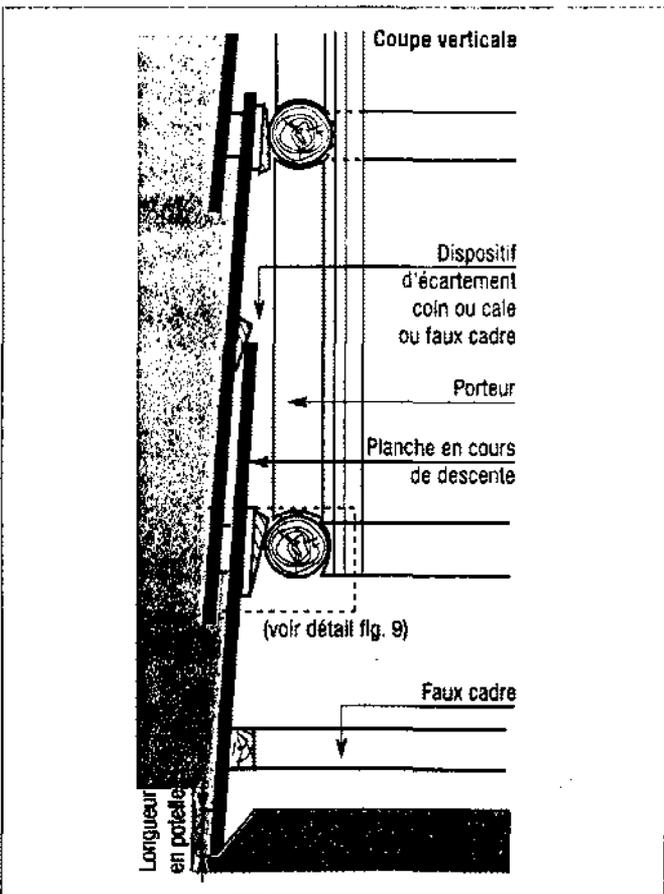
Descente des planches avec utilisation d'un faux cadre.
